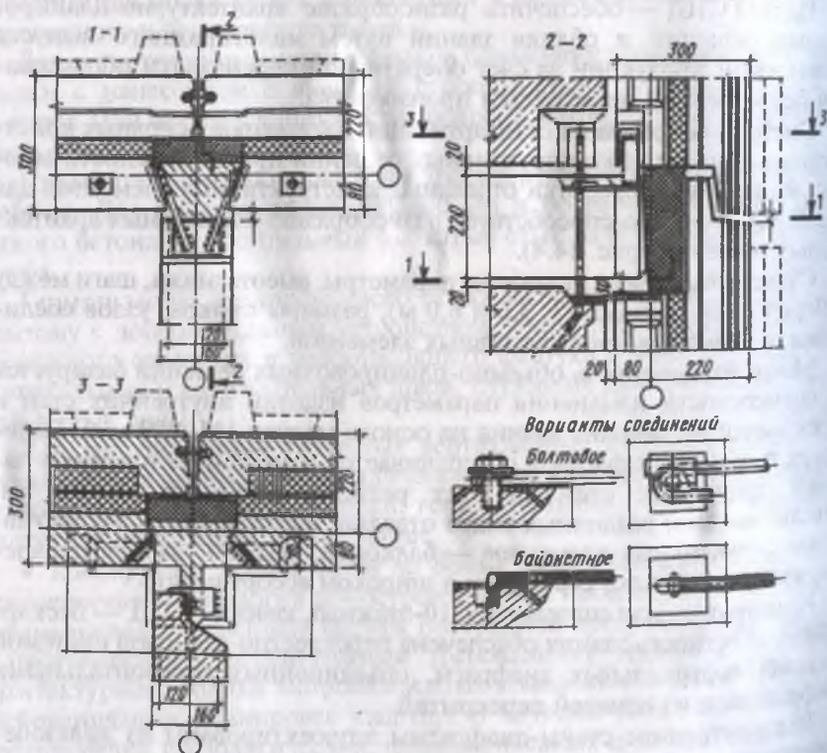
Монтажные узлы сопряжения панелей наружных и внутренних стен
